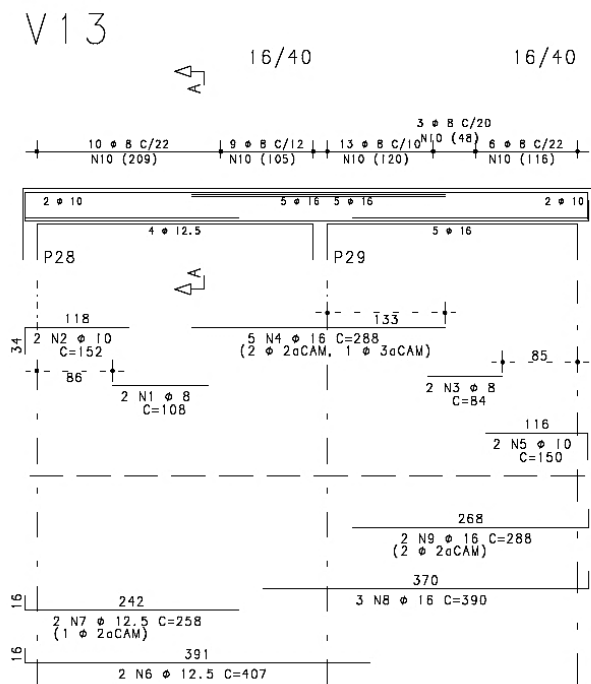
Desenho de armação – viga V13 – Modelo FVJ
